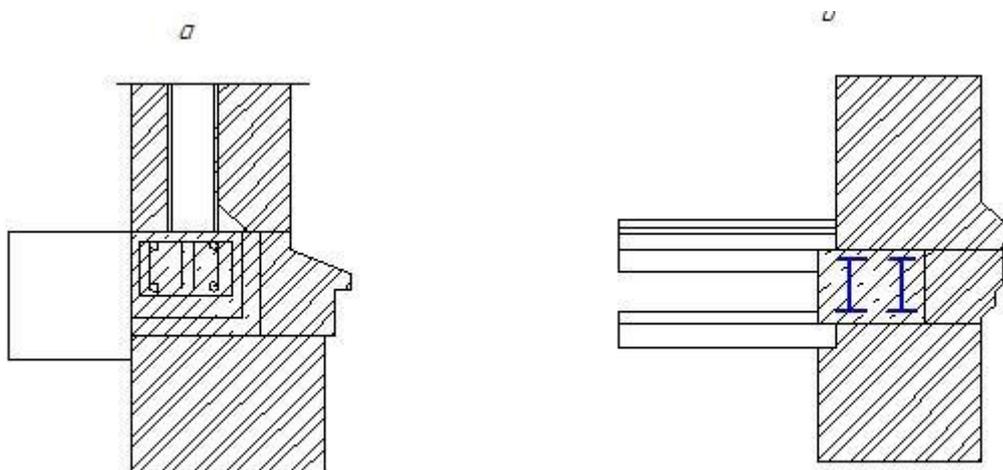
Пояса жесткости: а — железобетонный; б — стальной
